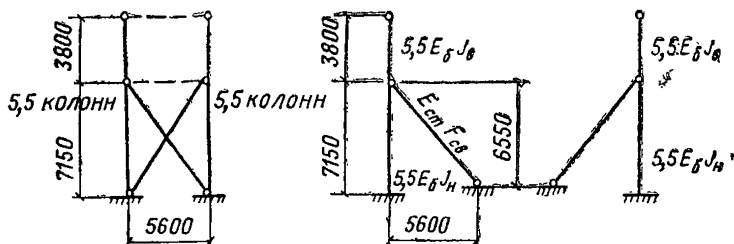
Расчетная схема крайнего продольного ряда колонн каркаса
